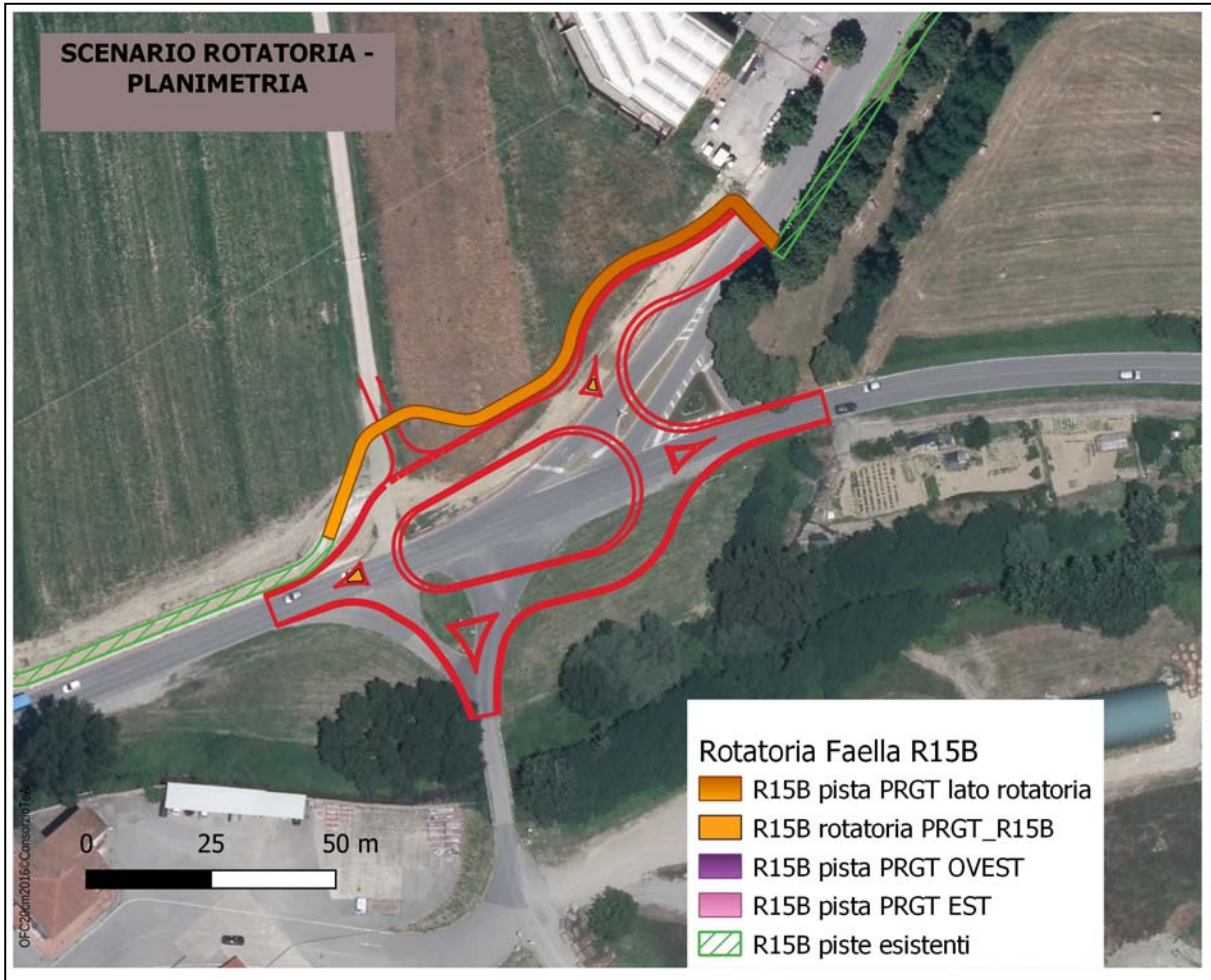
Planimetria scenario "A" rotatoria- sovrapposizione con ortofoto RT2010.
